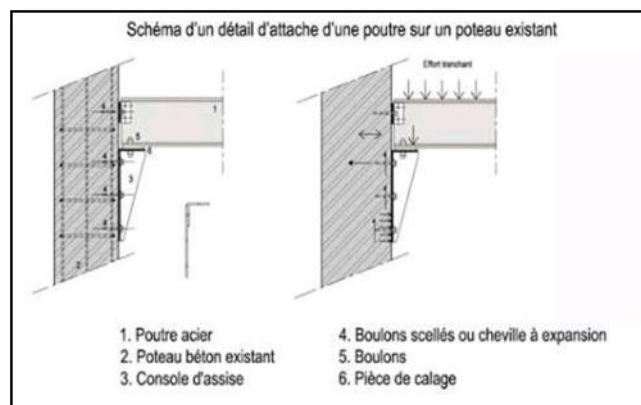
détail d'assemblage poteau Béton armé / poutre métallique
